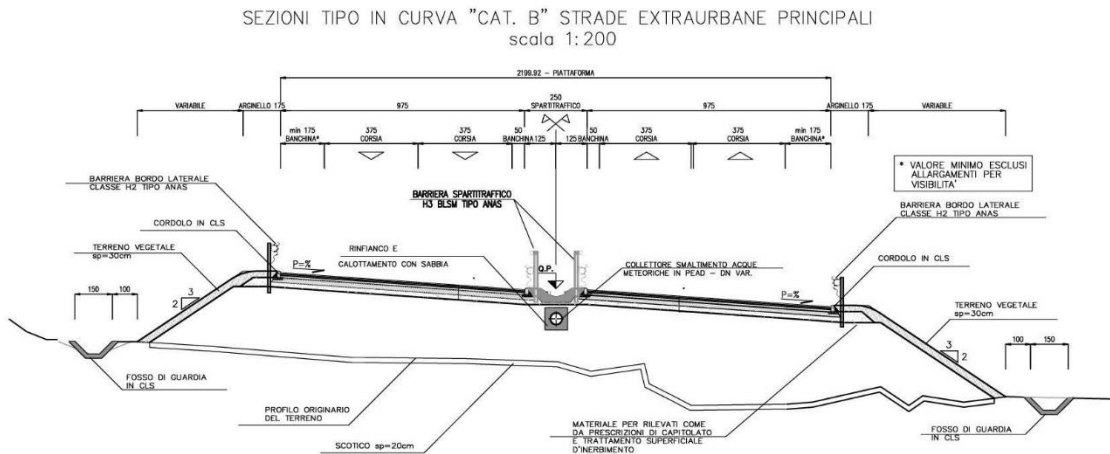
Asse principale, sezione tipo nel tratto di progetto.
